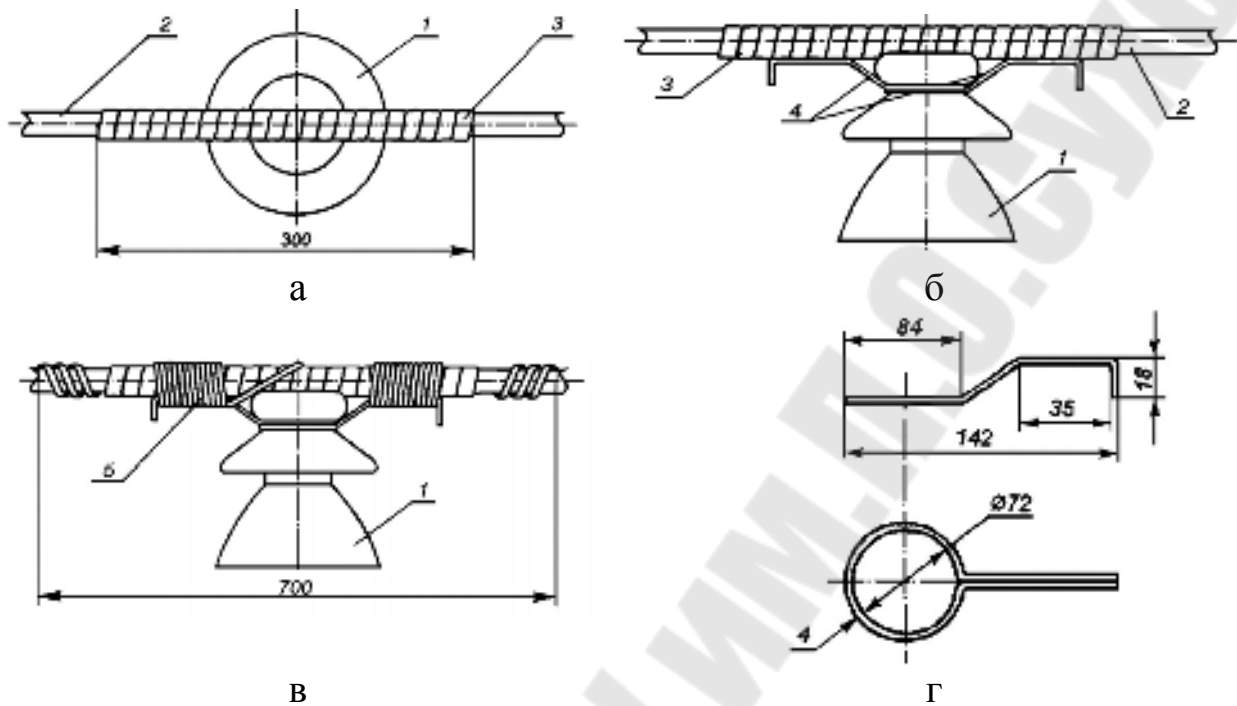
Демпферная вязка проводов ВЛ 6-10 кВ: а — вид сверху; б — вид сбоку; в — окончательный вид вязки (вид сбоку); г — металлическая рамка; 1 — изолятор ШФ10; 2 — провод; 3 — алюминиевая лента 0,5x10x900 мм; 4 — металлическая рамка оцинкованная — 2 шт.; 5 — алюминиевая проволока диаметром 3 мм и длиной 3 м.
